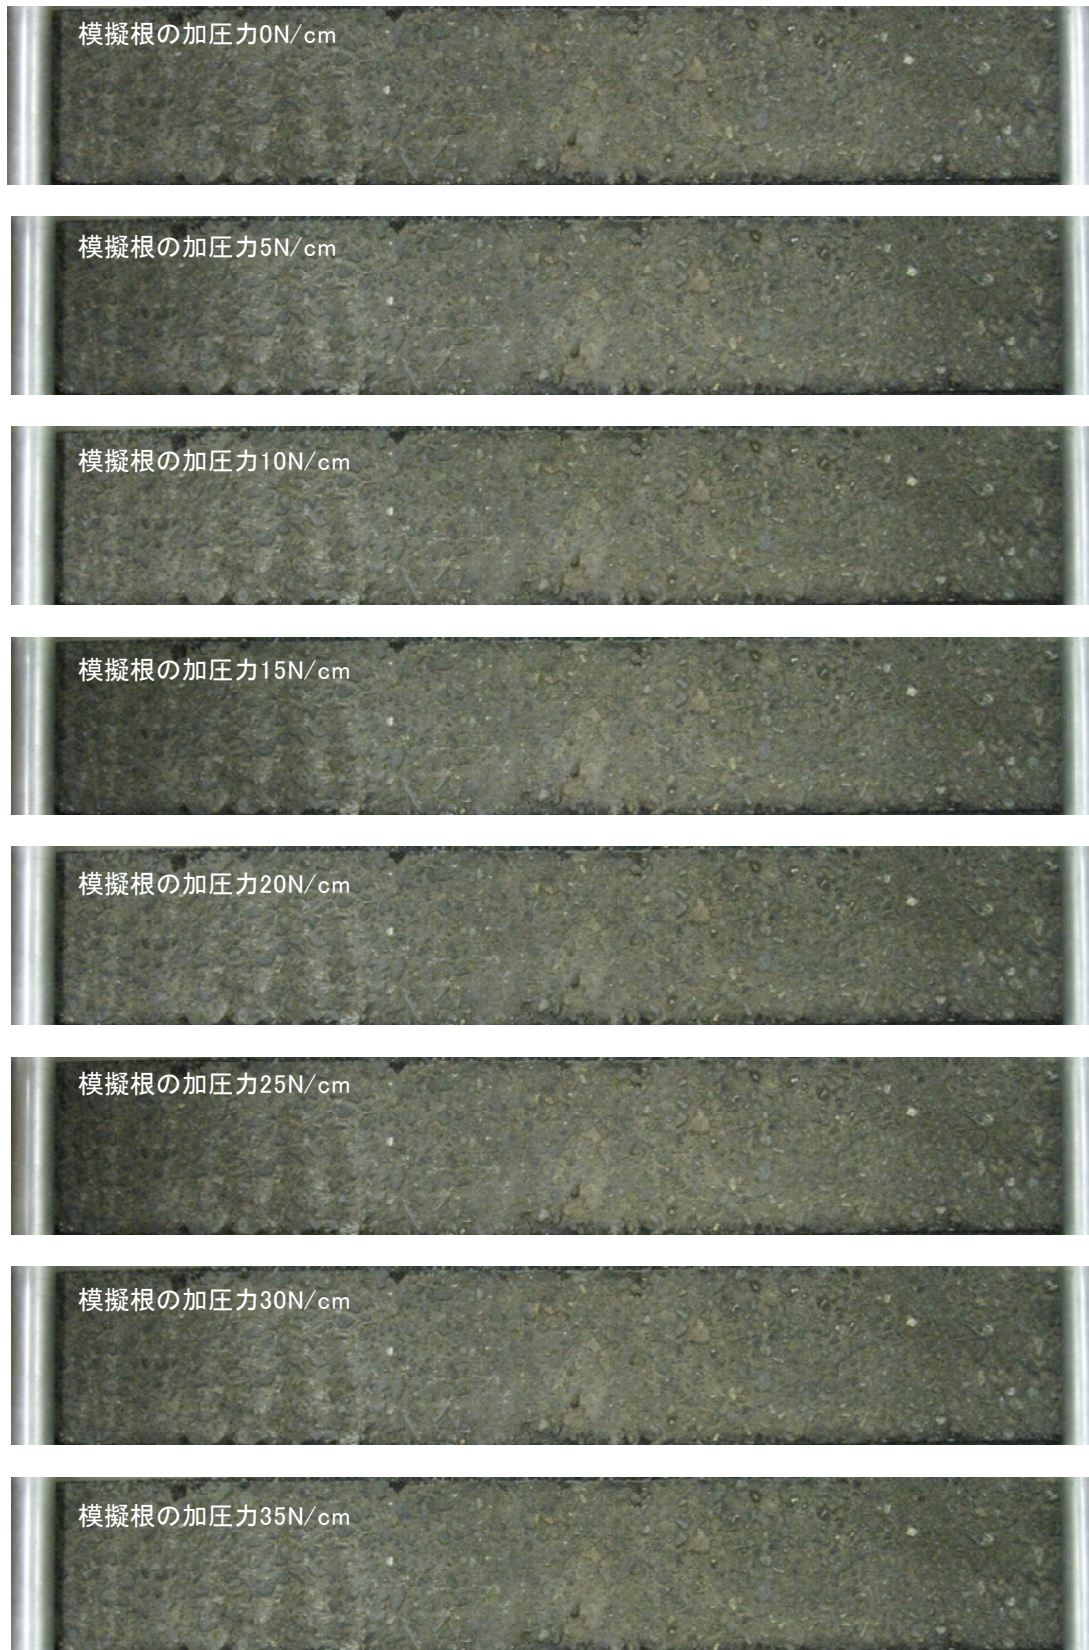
アスファルト舗装表面のひび割れ状態の一例(模擬根直上の砂層の厚さ0mm) 1/2
